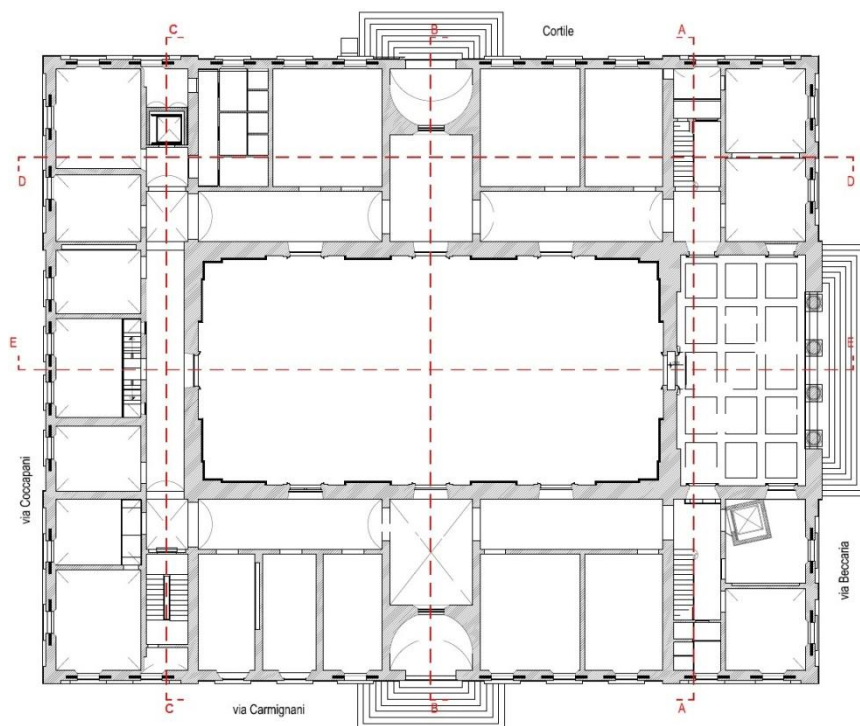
Indicazione delle sezioni su planimetria del piano terra
